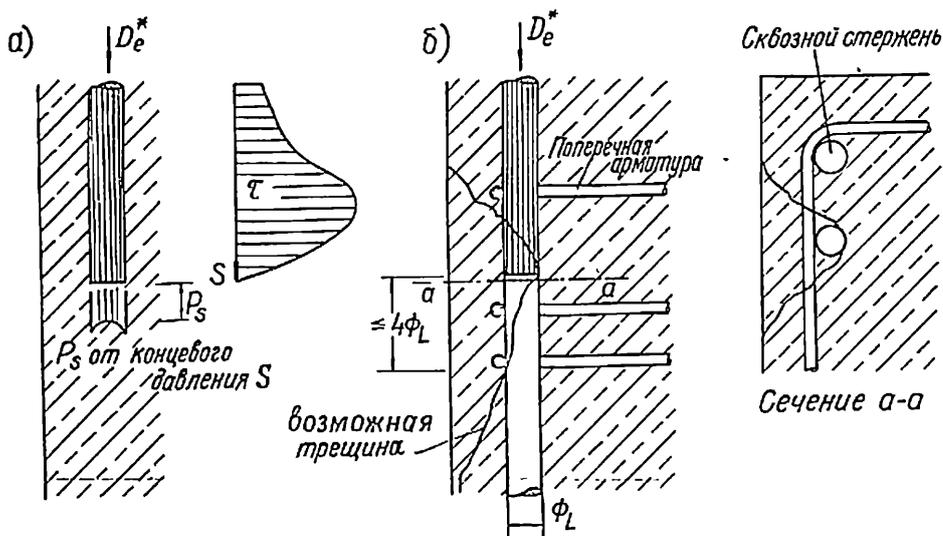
I7. Давление S , передаваемое торцом у сжатых стержней. Опасность раскалывания из-за давления торца благодаря поперечной арматуре, охватывающей стержни, может быть снижена
